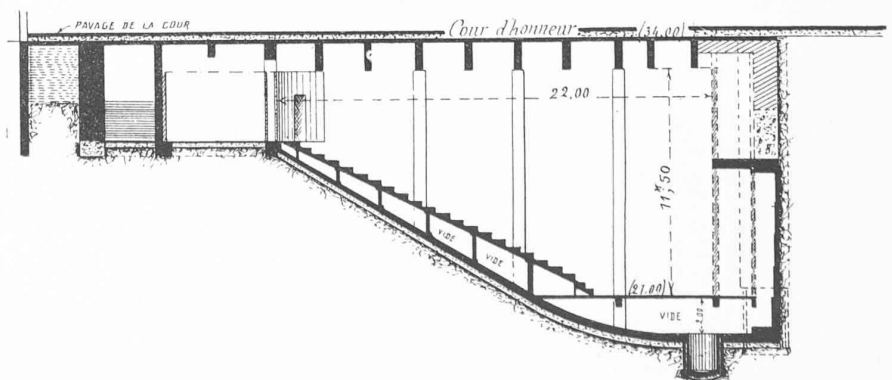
Coupe longitudinale sur l'amphithéâtre central, les cloisons en briques sur colonnes supposées non construites.
